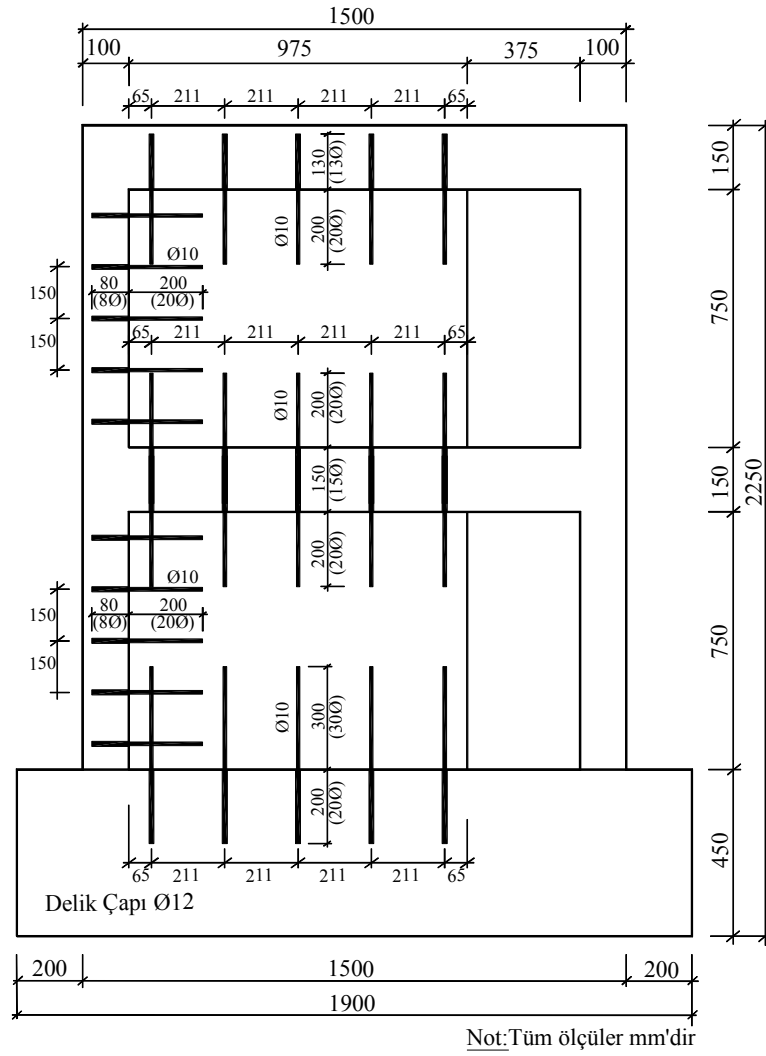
Deney Elemanı-6'nın donatı detayı
